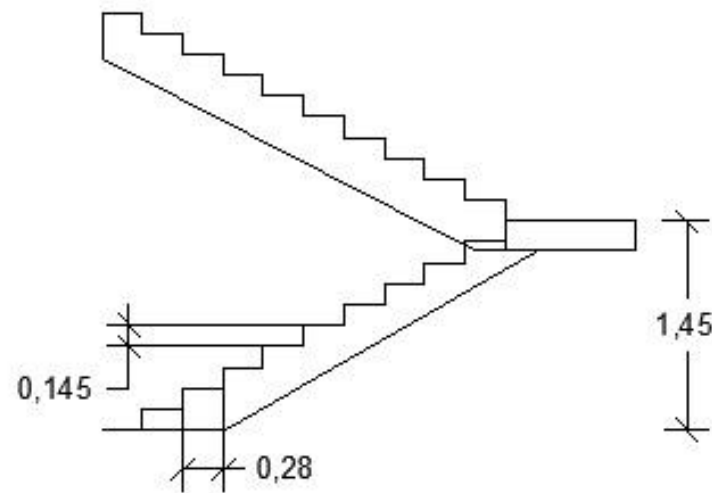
Detalle de las escaleras. Fuente: elaboración propia
